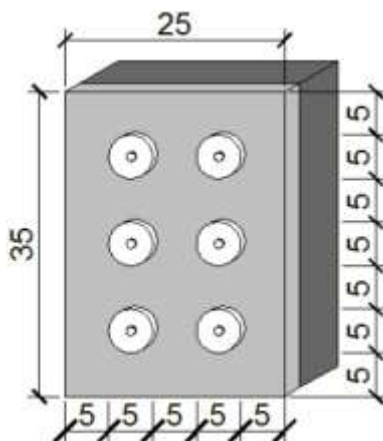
Esquema de extração dos cp's nas placas de concreto, para o ensaio de aderência (medidas em cm)
